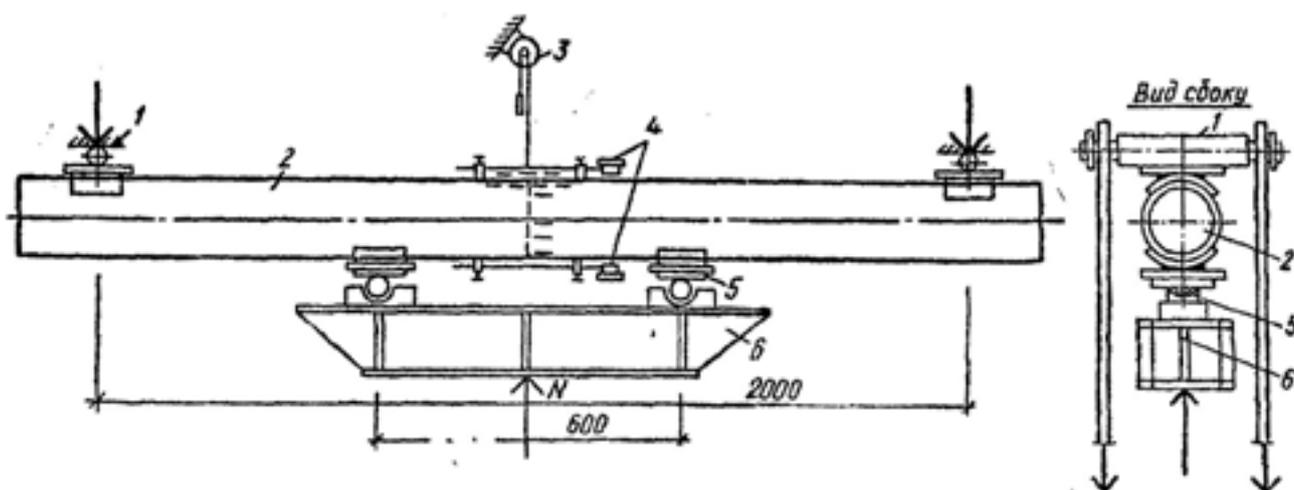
Схема загрузки образцов серии ИВ-2; 1 – опора; 2 – образец; 3 – прогибомер; 4 – индикаторы, 5 – цилиндрический шарнир; 6 – траверса
